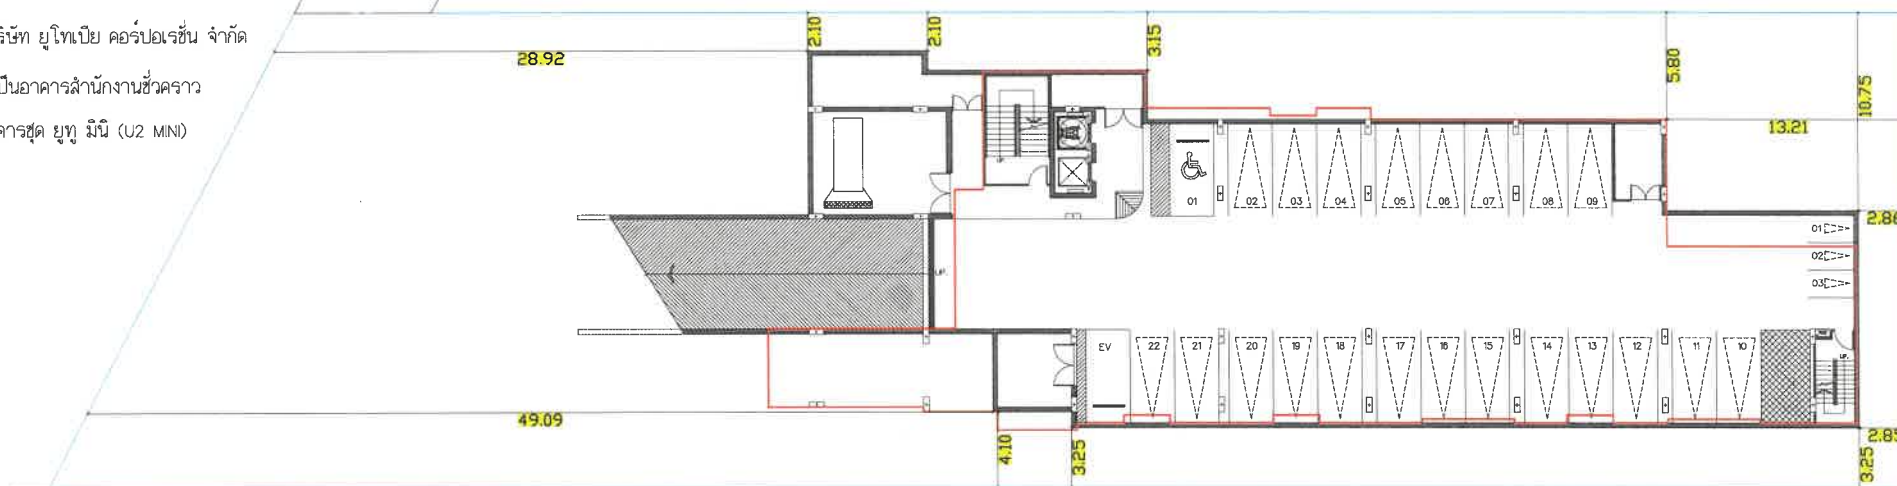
ผังบริเวณโครงการ ชั้น 1
